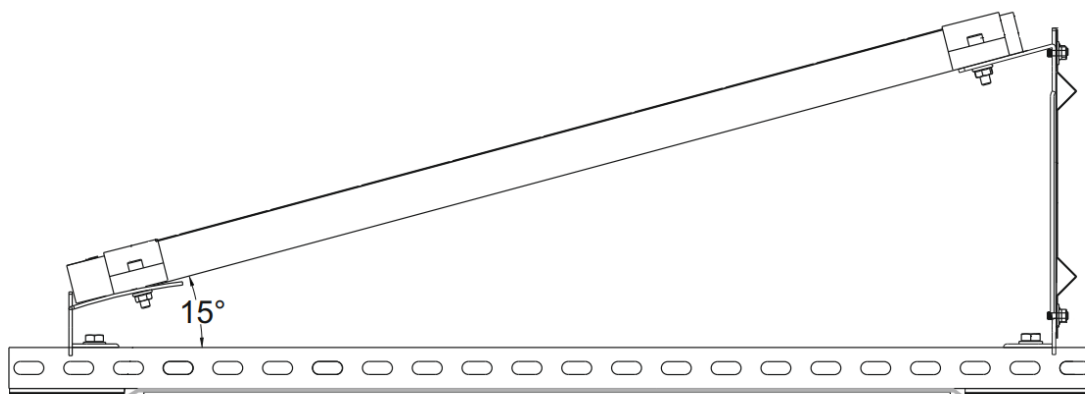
Przykład systemu z wykorzystaniem systemu na dachu pokrytym blachą trapezową.
